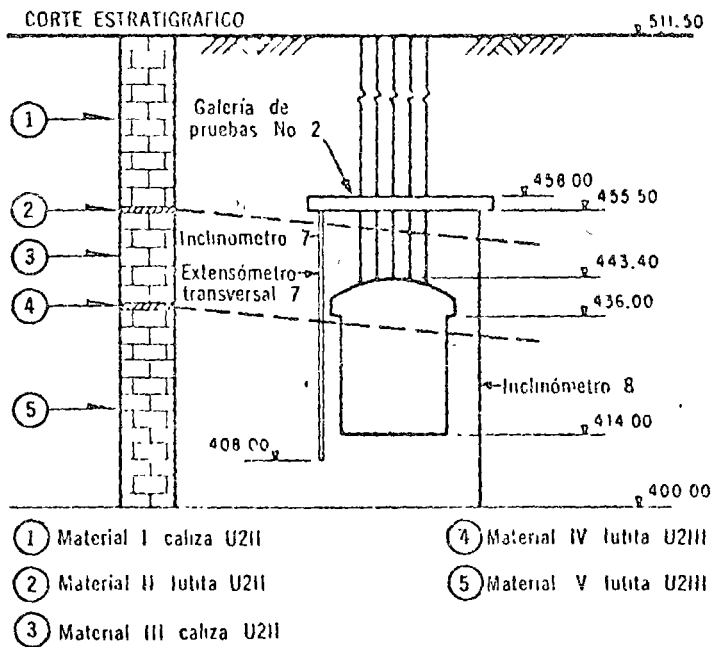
Corte en la galería de pruebas N° 2. Presa La Angostura, Chis.
